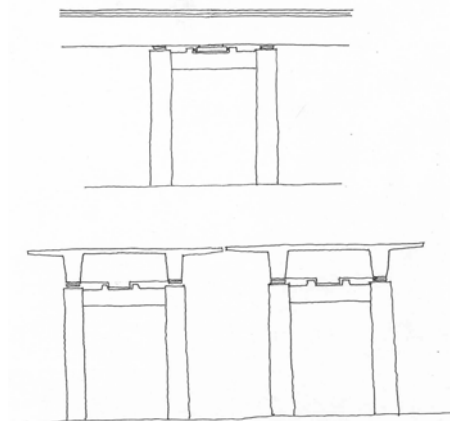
Fine corsa sismici ed elementi di bloccaggio per il fissaggio longitudinale di ponti appoggiati su elementi di neoprene o teflon.
